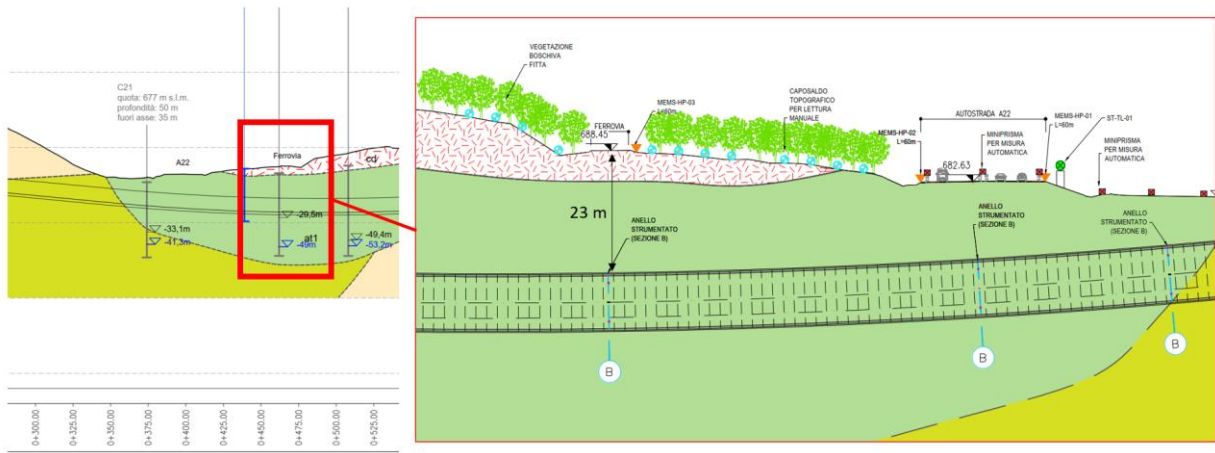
Stralci del profilo geotecnico della zona di interesse (a sinistra) e sezione dettagliata (a destra) per la pk 0+470
